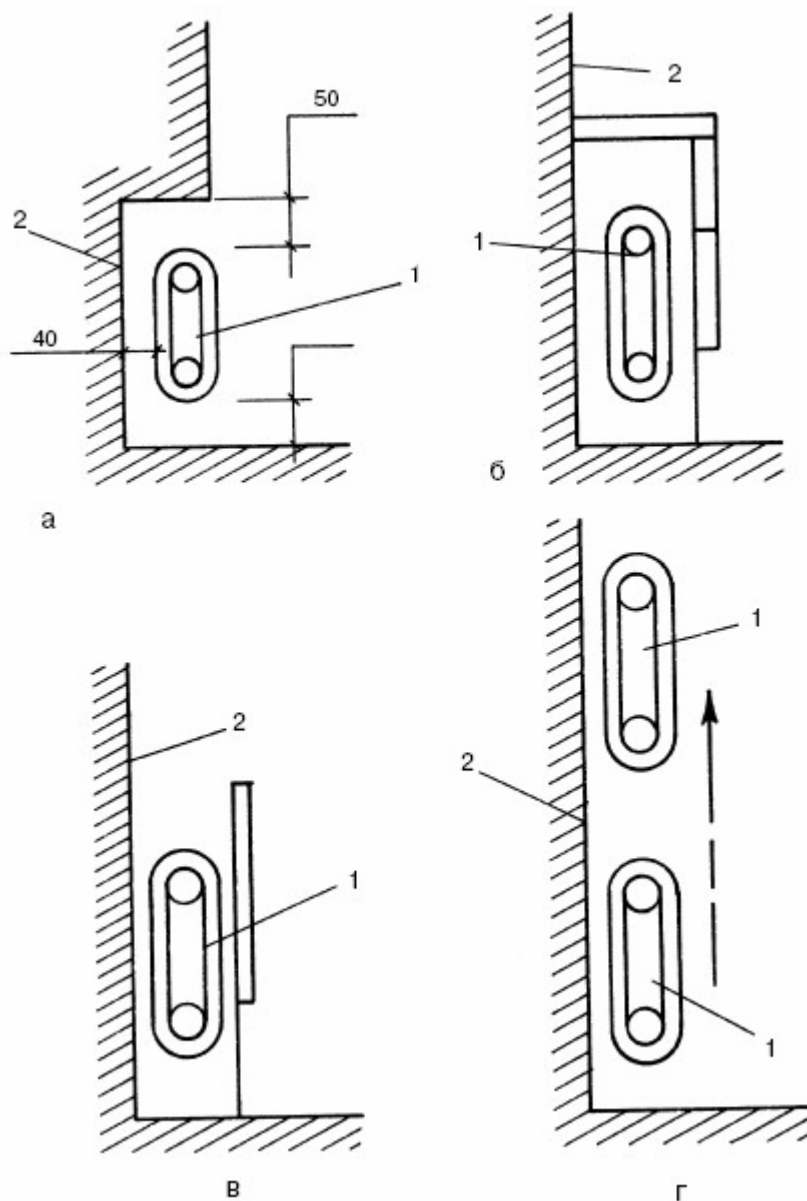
Варианты размещения отопительных приборов: а – в нише стены; б – в специальном укрытии; в – за щитом; г – в два яруса (один над другим); 1 – отопительный прибор; 2 – стена
